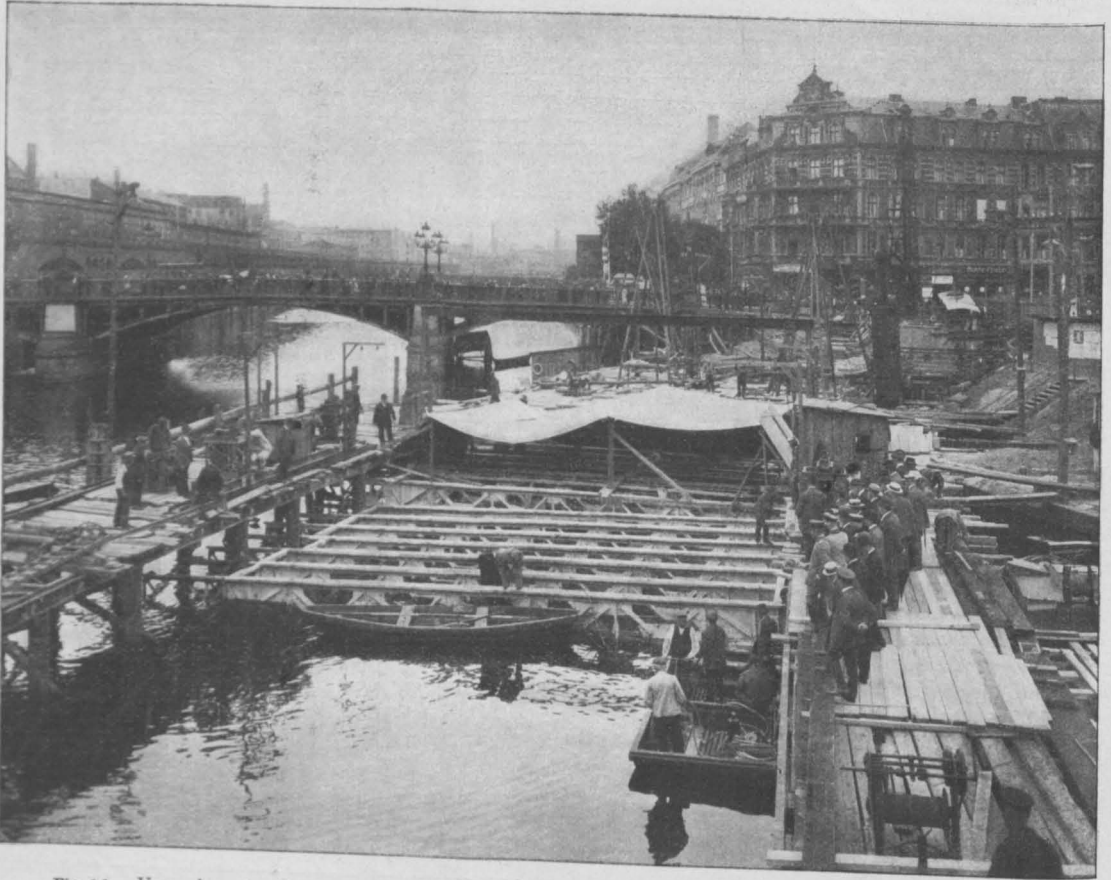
Versenken des Trägergerüsts für die Eisenbetondecke des Spreetunnels an der Jannowitzbrücke.
